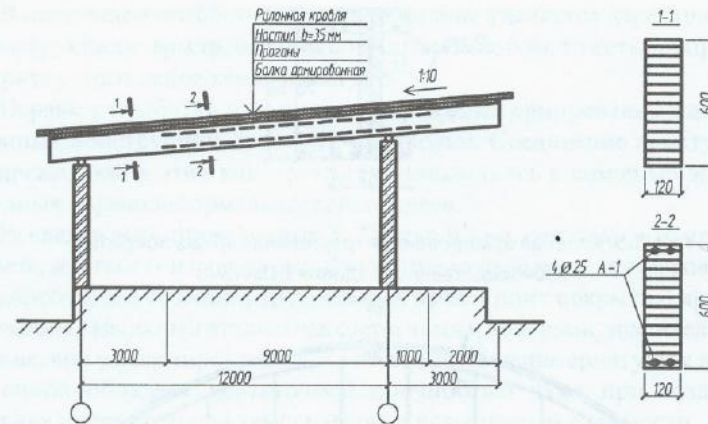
Клееные армированные балки переменной жесткости в покрытии складского здания (г. Владимир)
